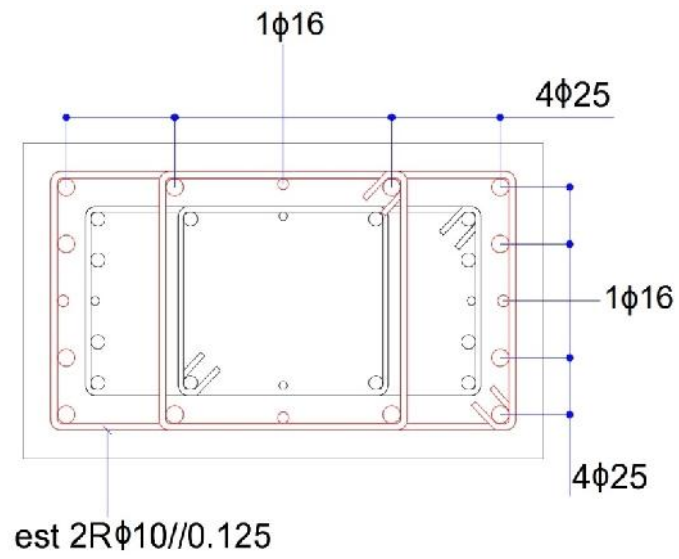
Pormenorização da zona crítica da secção encamisada do pilar B1 do piso 0
